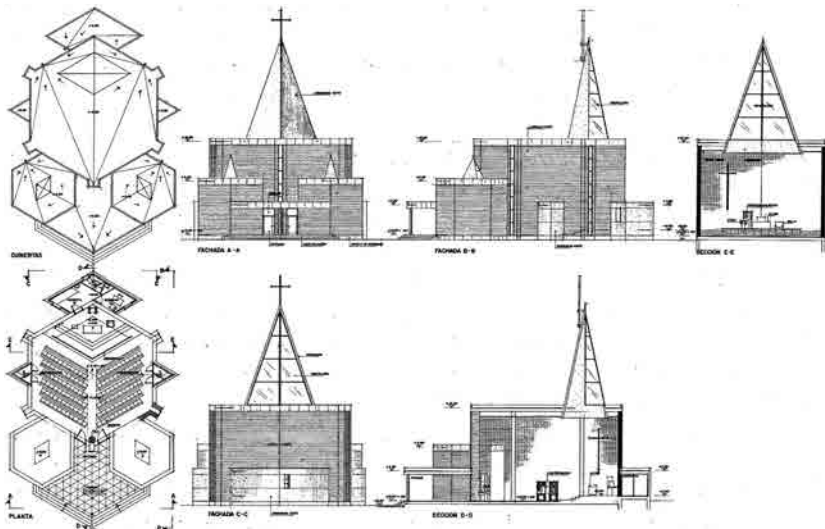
, Fig. 50, Fig. 51, Fig. 52, Fig. 53, Fig. 54 y Fig. 55 Capilla de los Centros de Toledo y de Las Palmas. De izquierda a derecha: planta de cubiertas, alzado frontal, alzado lateral, sección transversal, planta, alzado posterior y sección longitudinal.
